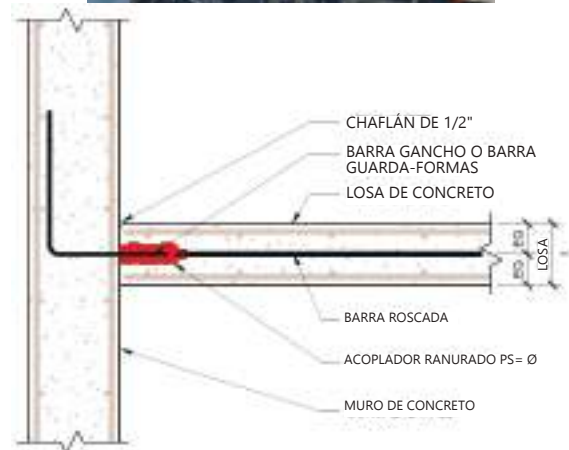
Junta de alivio PS=Ø entre losa y muro.
